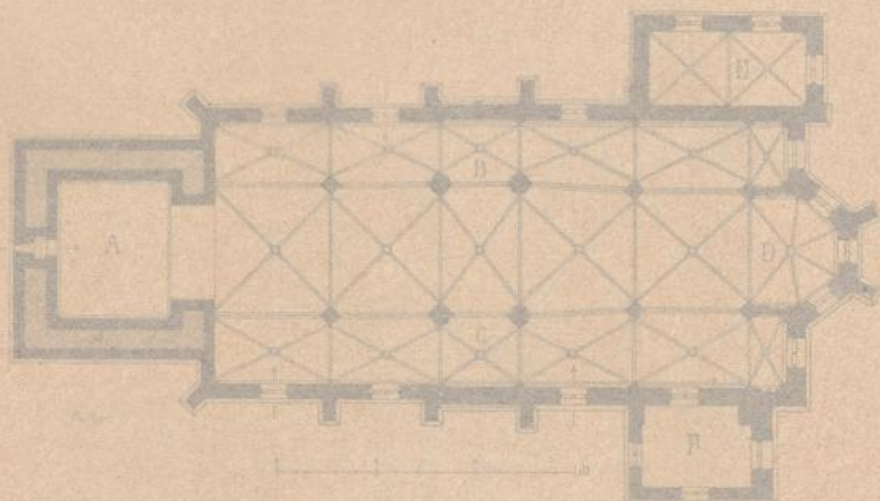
Ratingen. Grundriss der katholischen Pfarrkirche.
